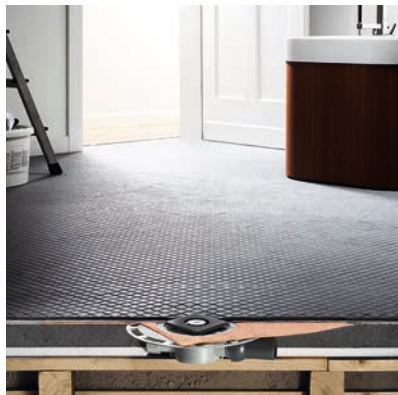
92 Sumidouro de pavimento - Extra plano
